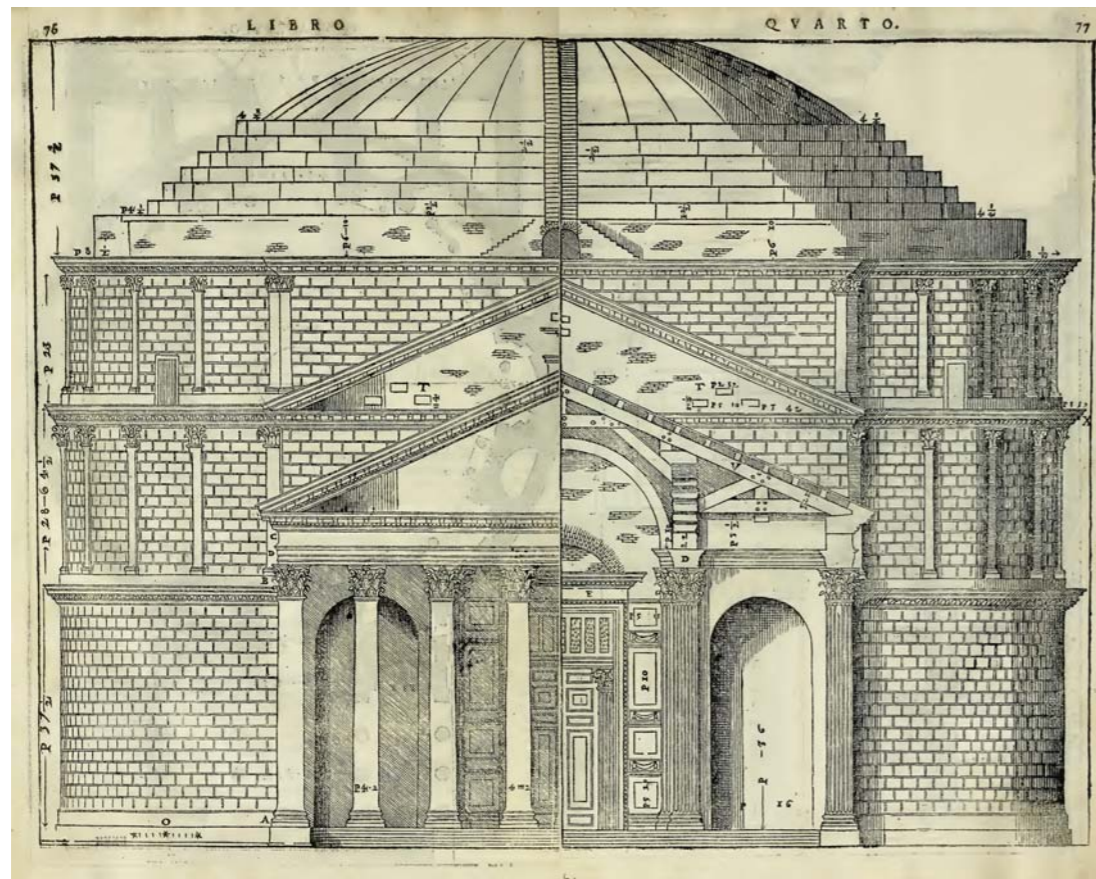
PALLADIO, Andrea – Panteão, Roma. Reprodução de metade da fachada principal e de metade da secção pelo pórtico da entrada, 1570.
